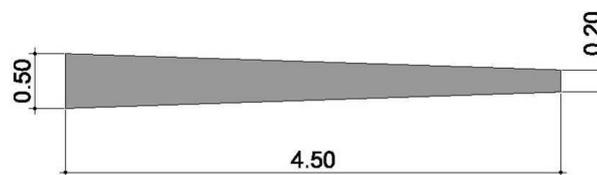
Planta do Pilar Principal. Desenho do autor – adaptado de planta original (IPHAN).
